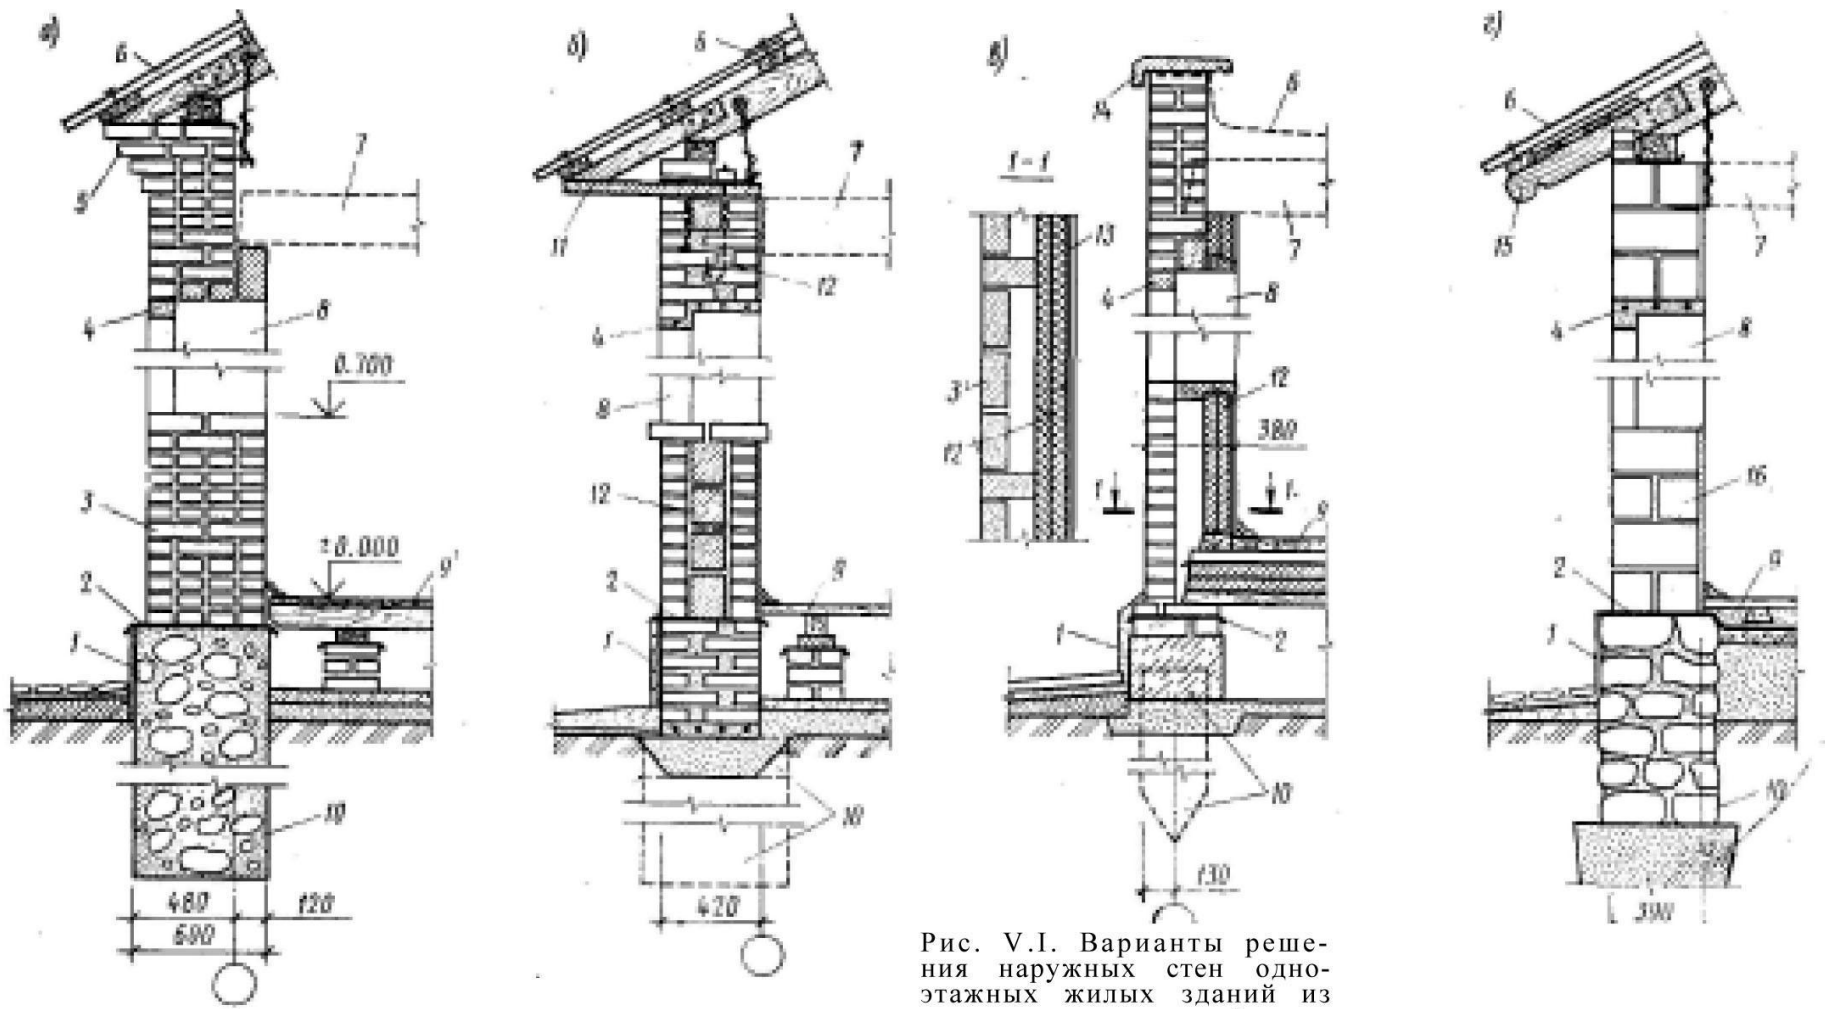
Рис. V.I. Варианты решения наружных стен одноэтажных жилых зданий из искусственных камней ручной кладки в композиции с элементами дома:
